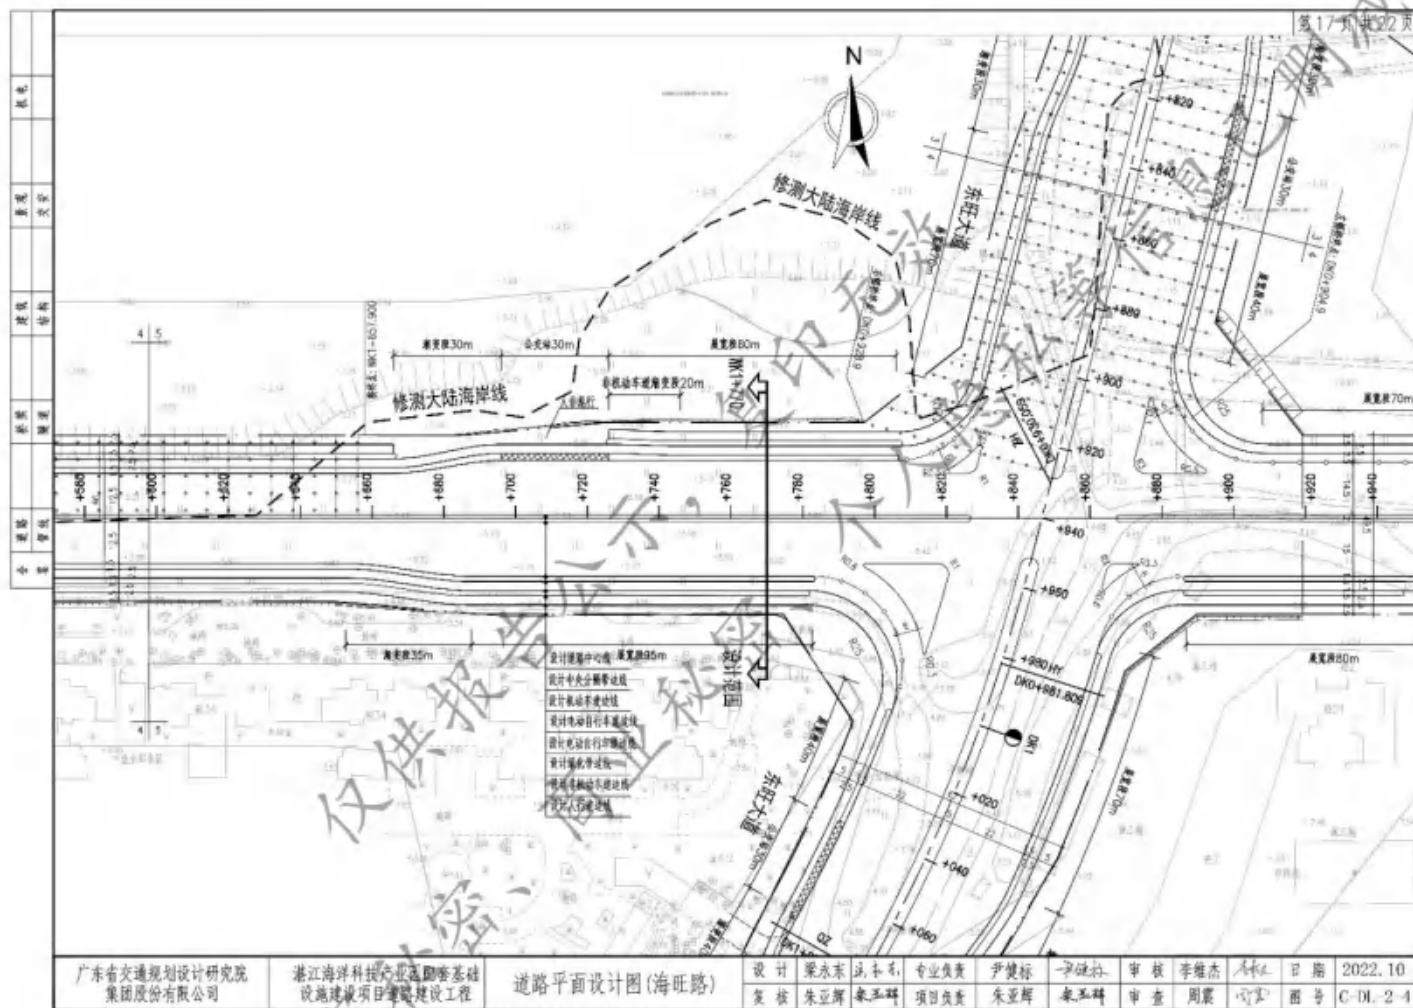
海旺路 3 号桥总平面布置图 (3)
